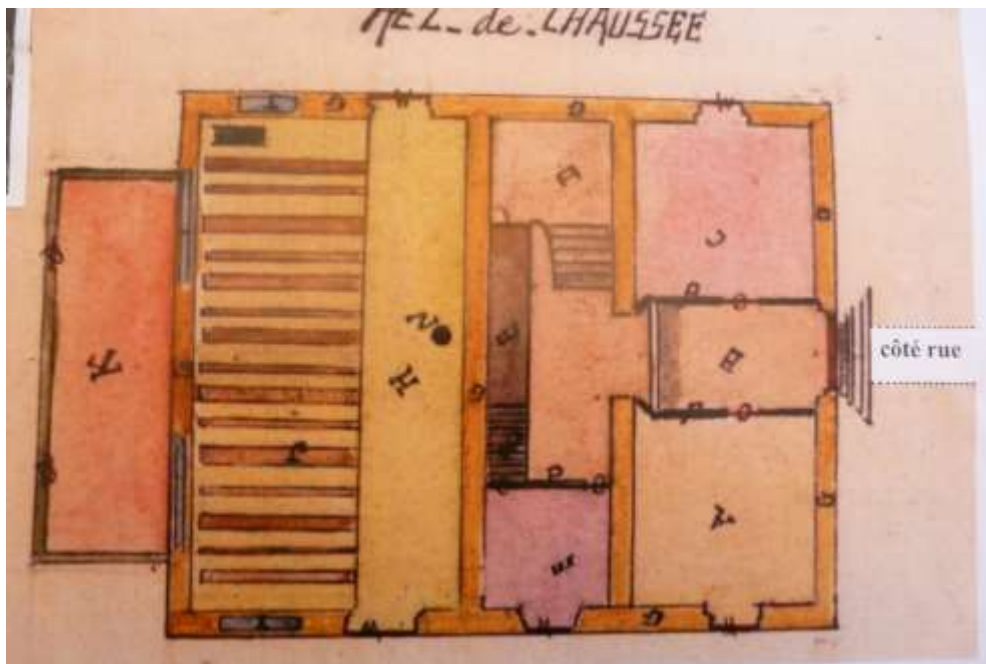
Intérieur du bâtiment, rez-de-chaussée.
